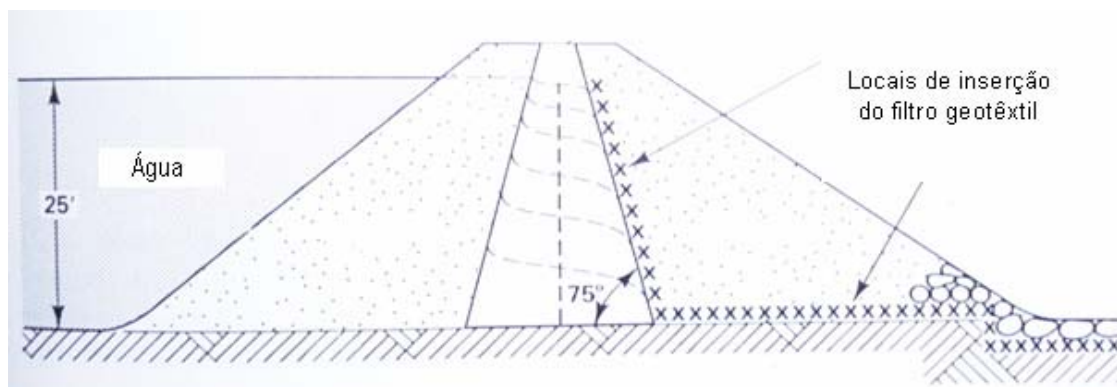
Ilustração de geotêxtil aplicado em dreno-chaminé de uma barragem (modificado – Koerner, 1994).
